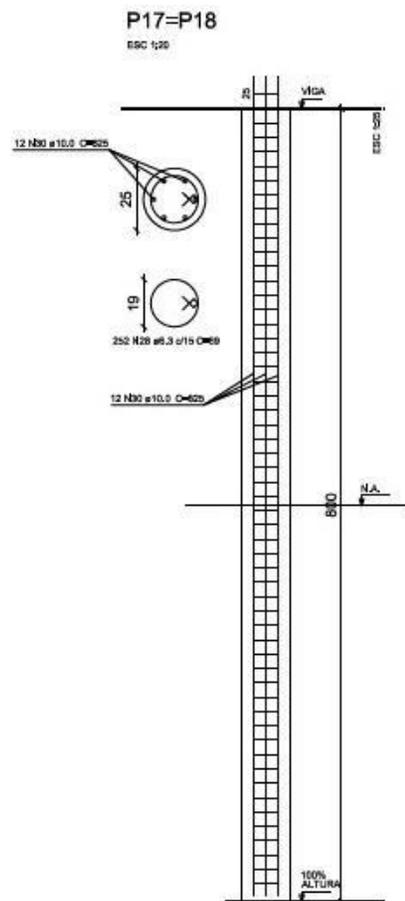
Detalhe dos pilares executados fora do enrocamento. Sem escala.
